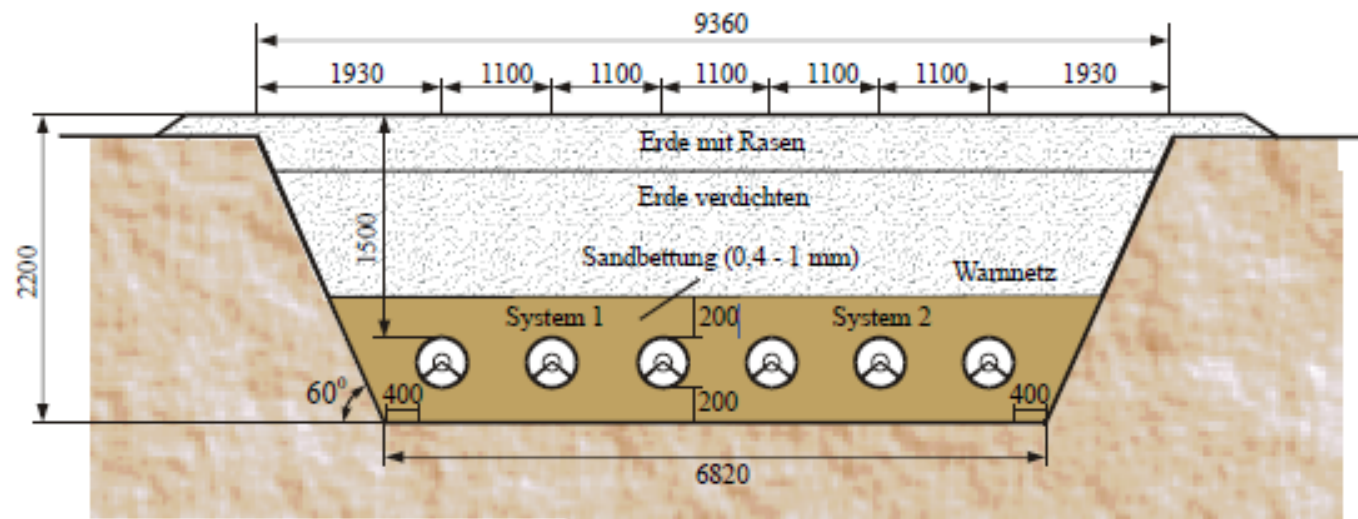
Grabenprofil mit 2 Systemen 380-kV-GIL. Maße in mm. (Quelle Siemens).
